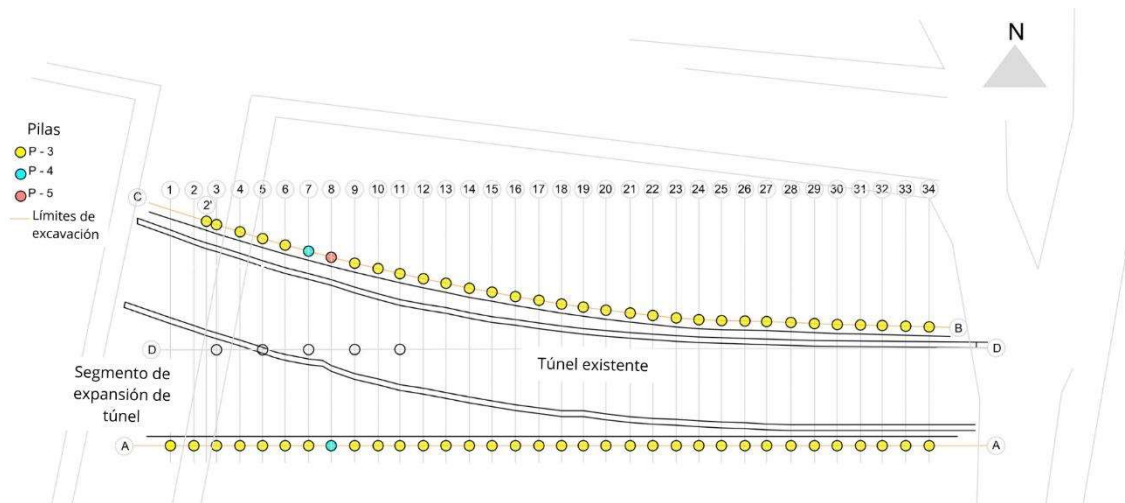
Planta de excavación a cielo abierto indicando armado para cada pilote.
